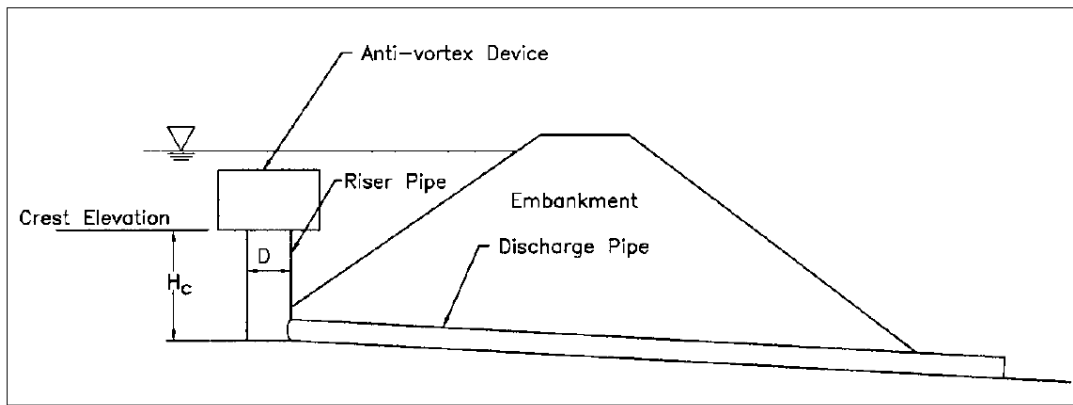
Esquema de instalação de tubagem elevada (U. S. Department of Transportation, 2009)
